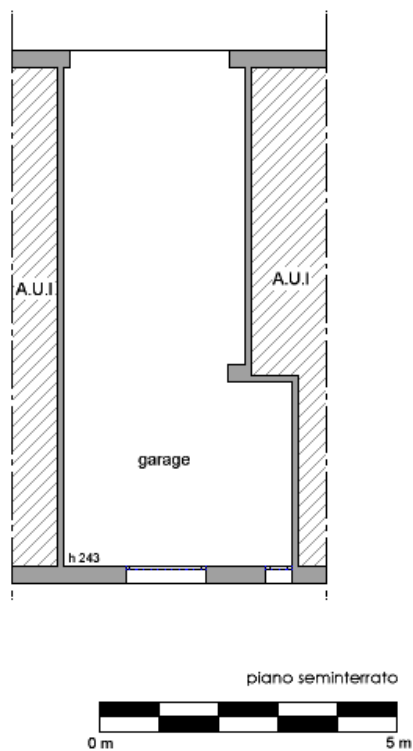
Planimetria piano seminterrato – ridisegno sommario
